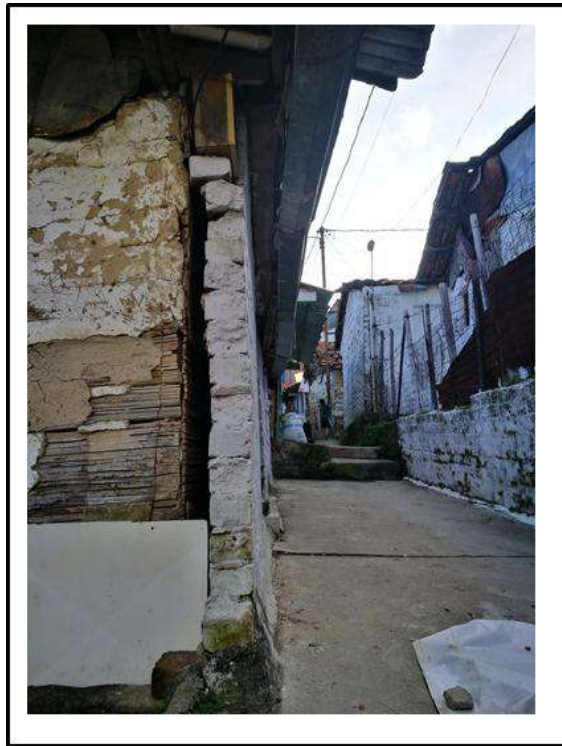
Materiales de construcción de las viviendas ubicadas en el barrio Chavarriaga Wilkins. Elaboración propia.
